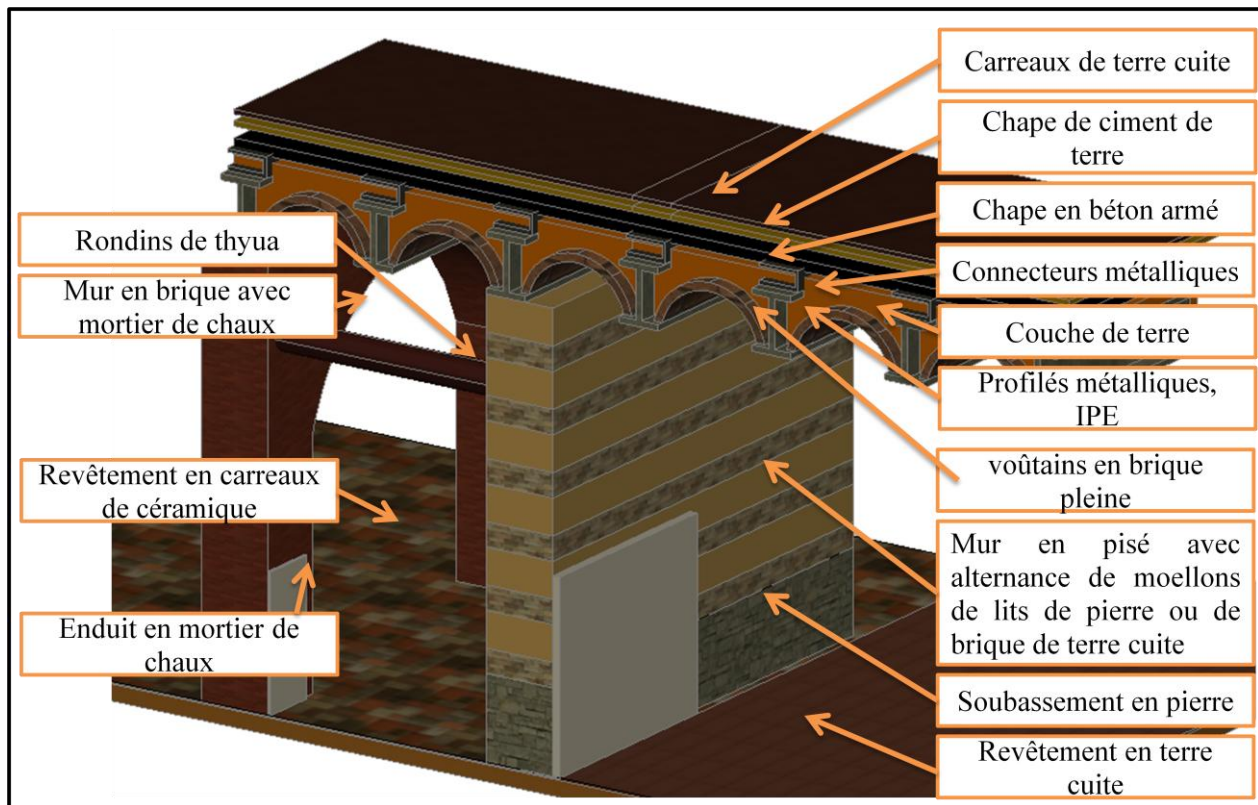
Typologie constructive avec plancher collaborant en voutains de brique+IPN et une chape en béton. Source: auteur.
